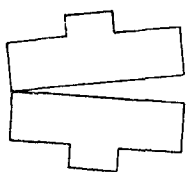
soit établi par une surface bombée (FIG. 108) la bascule du pont (mouvement impossible à éviter dans certaines limites) pourra de cette façon se produire tout en conservant aux surfaces planes des lentilles un contact parfait, c'est-à-dire sans diminuer la facilité de rotation du pont, on réalisera ainsi l'avantage des lentilles bombées des FIG. 106 et 107 tout en évitant leur grand inconvénient.
